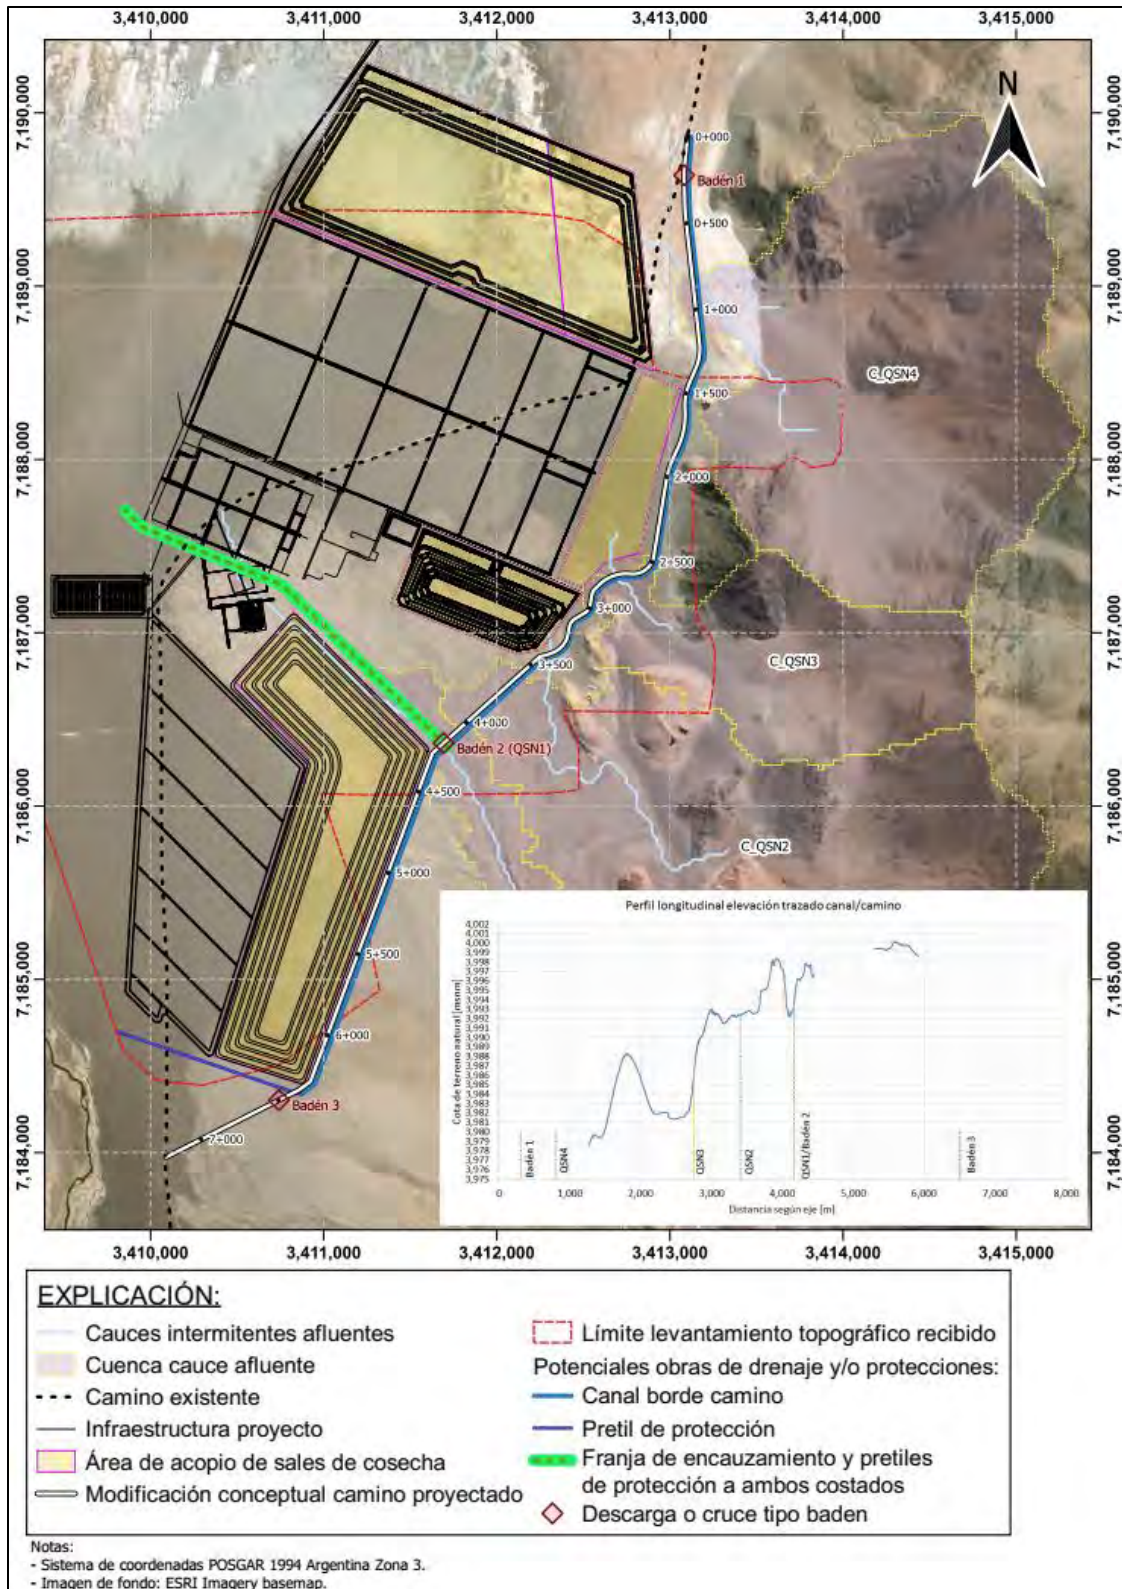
Propuesta conceptual de obras de drenaje y protección, planta y perfil longitudinal esquemático
